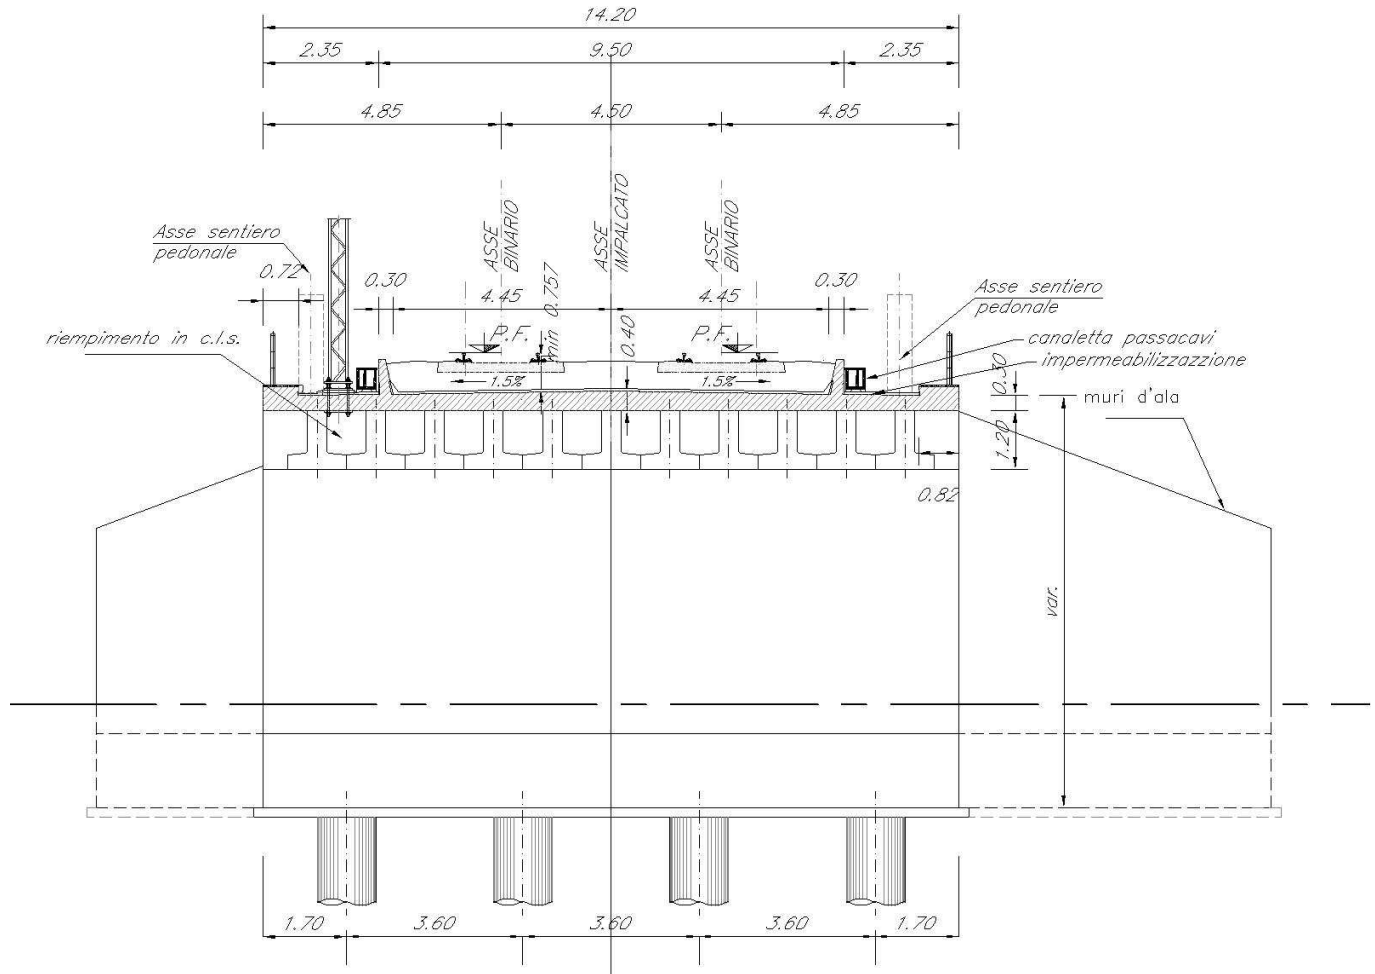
Prospetto/Sezione longitudinale in corrispondenza di attraversamento idraulico.
